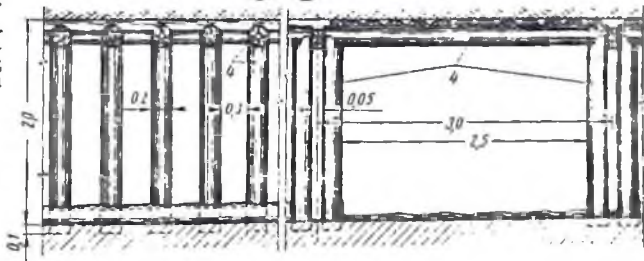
Крепление заходок монтажного слоя и гибкое перекрытие в монтажном слое:
